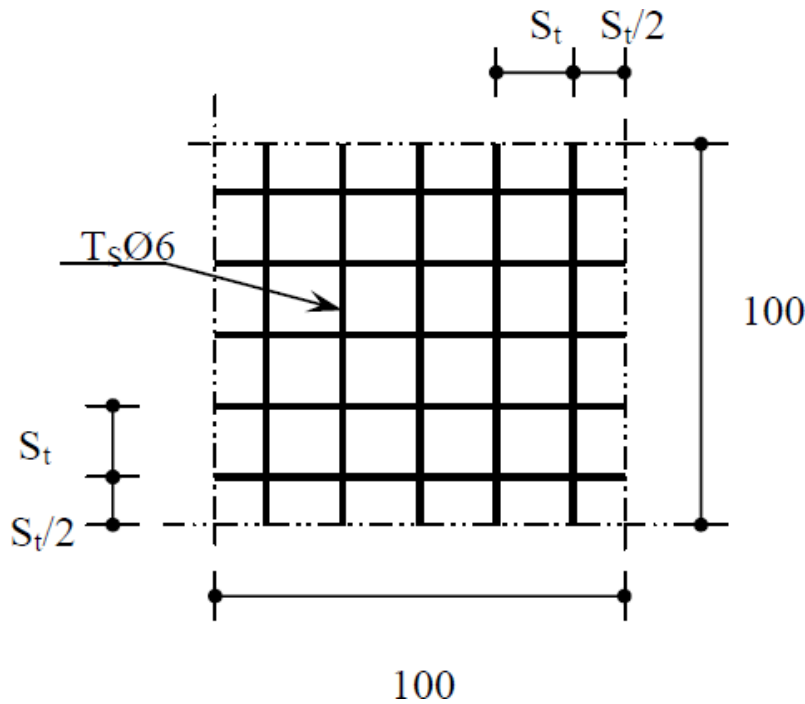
11: Disposition constructive des armatures de la dalle de compression
